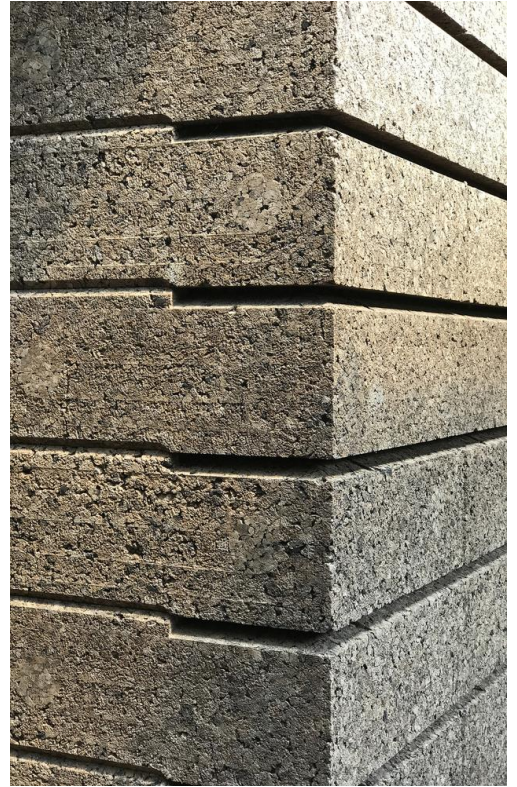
y 168. Bloques de corcho (ArchDaily, Paula Pintos, 2020).
